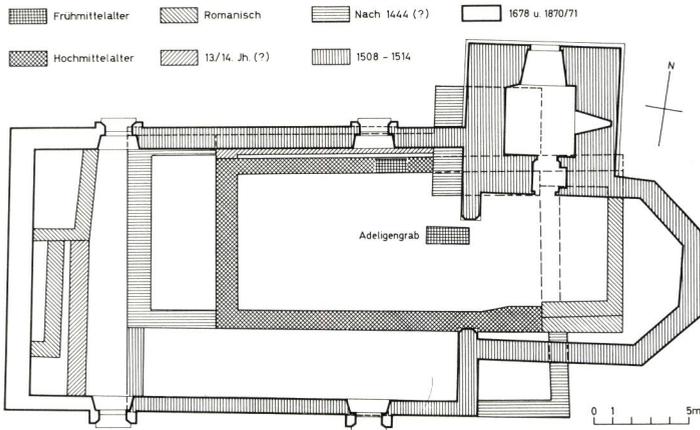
Bülach. Ref. Kirche. Bautappenplan mit den Grundrissen der Vorgängerbauten. Im Zentrum der frühmittelalterlichen bzw. merowingischen Kirche das Adeligengrab.
